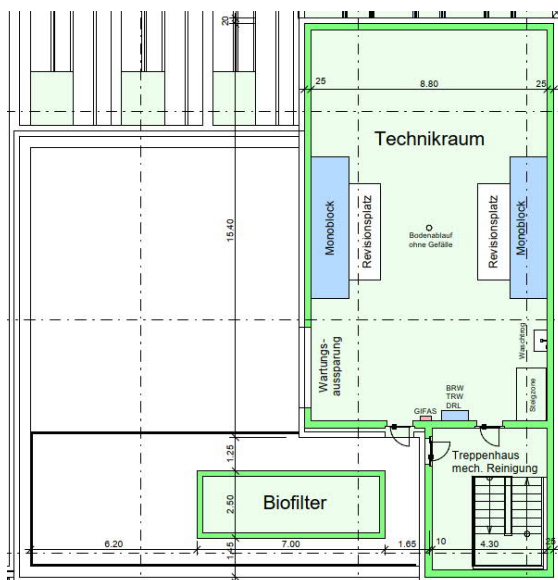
Planausschnitt; Grundriss OG
